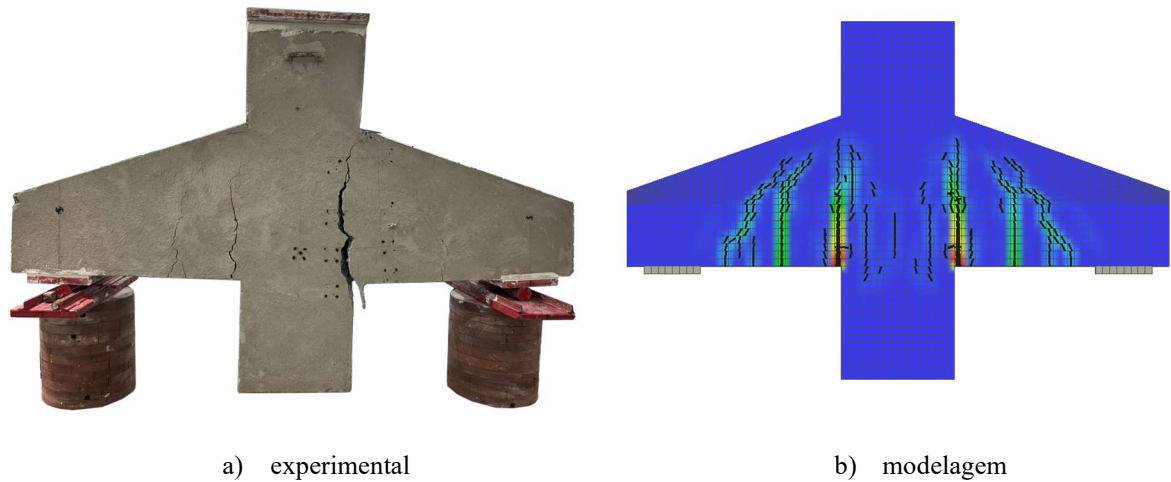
padrão de fissuração CRC - 0,47
